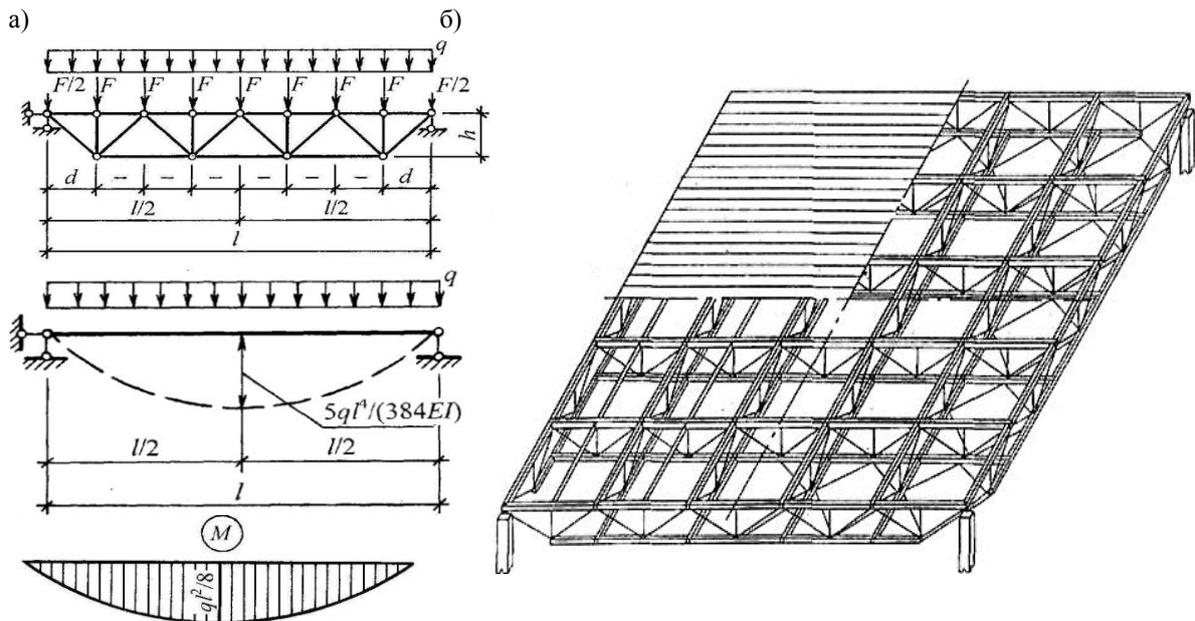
Расчетные схемы фермы и ее балочного аналога (а), а также аксонометрия системы перекрестных ферм в составе блока покрытия (б)
